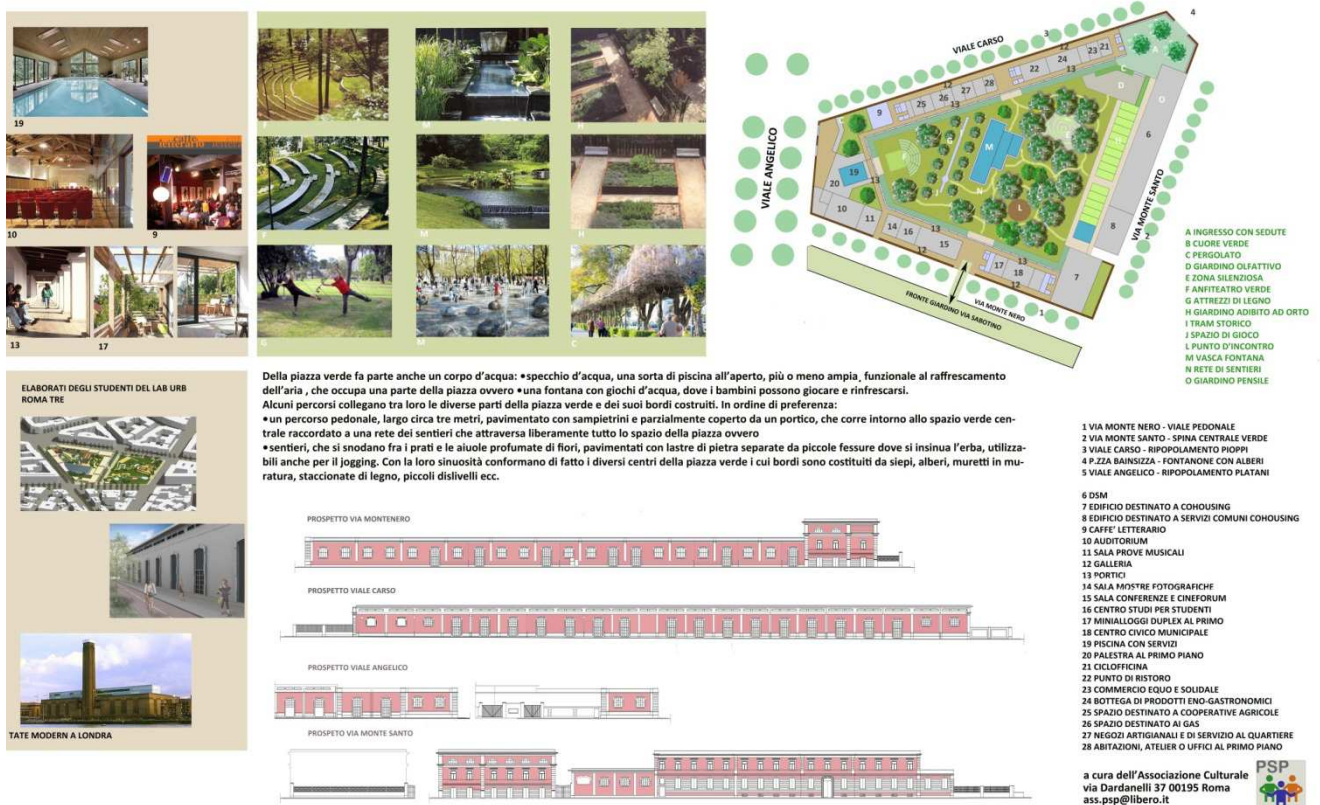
Riqualficazione e riuso dell'ex deposito ATAC Vittoria: planimetria del complesso e recupero delle facciate esterne
